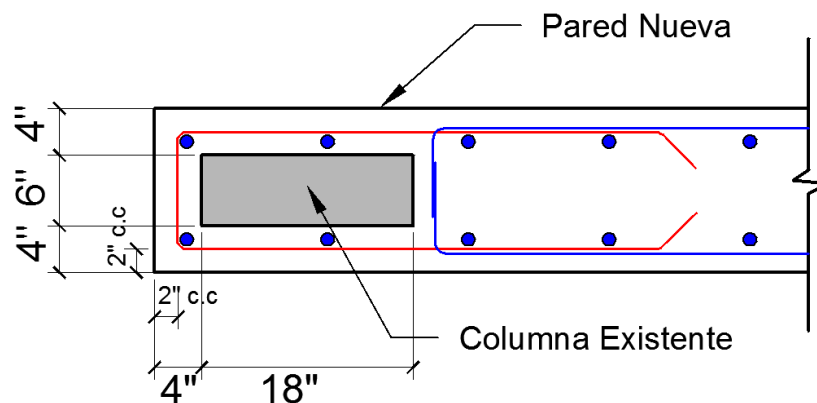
Pared Nueva Abrazando Columna Existente de 18" x 6"
